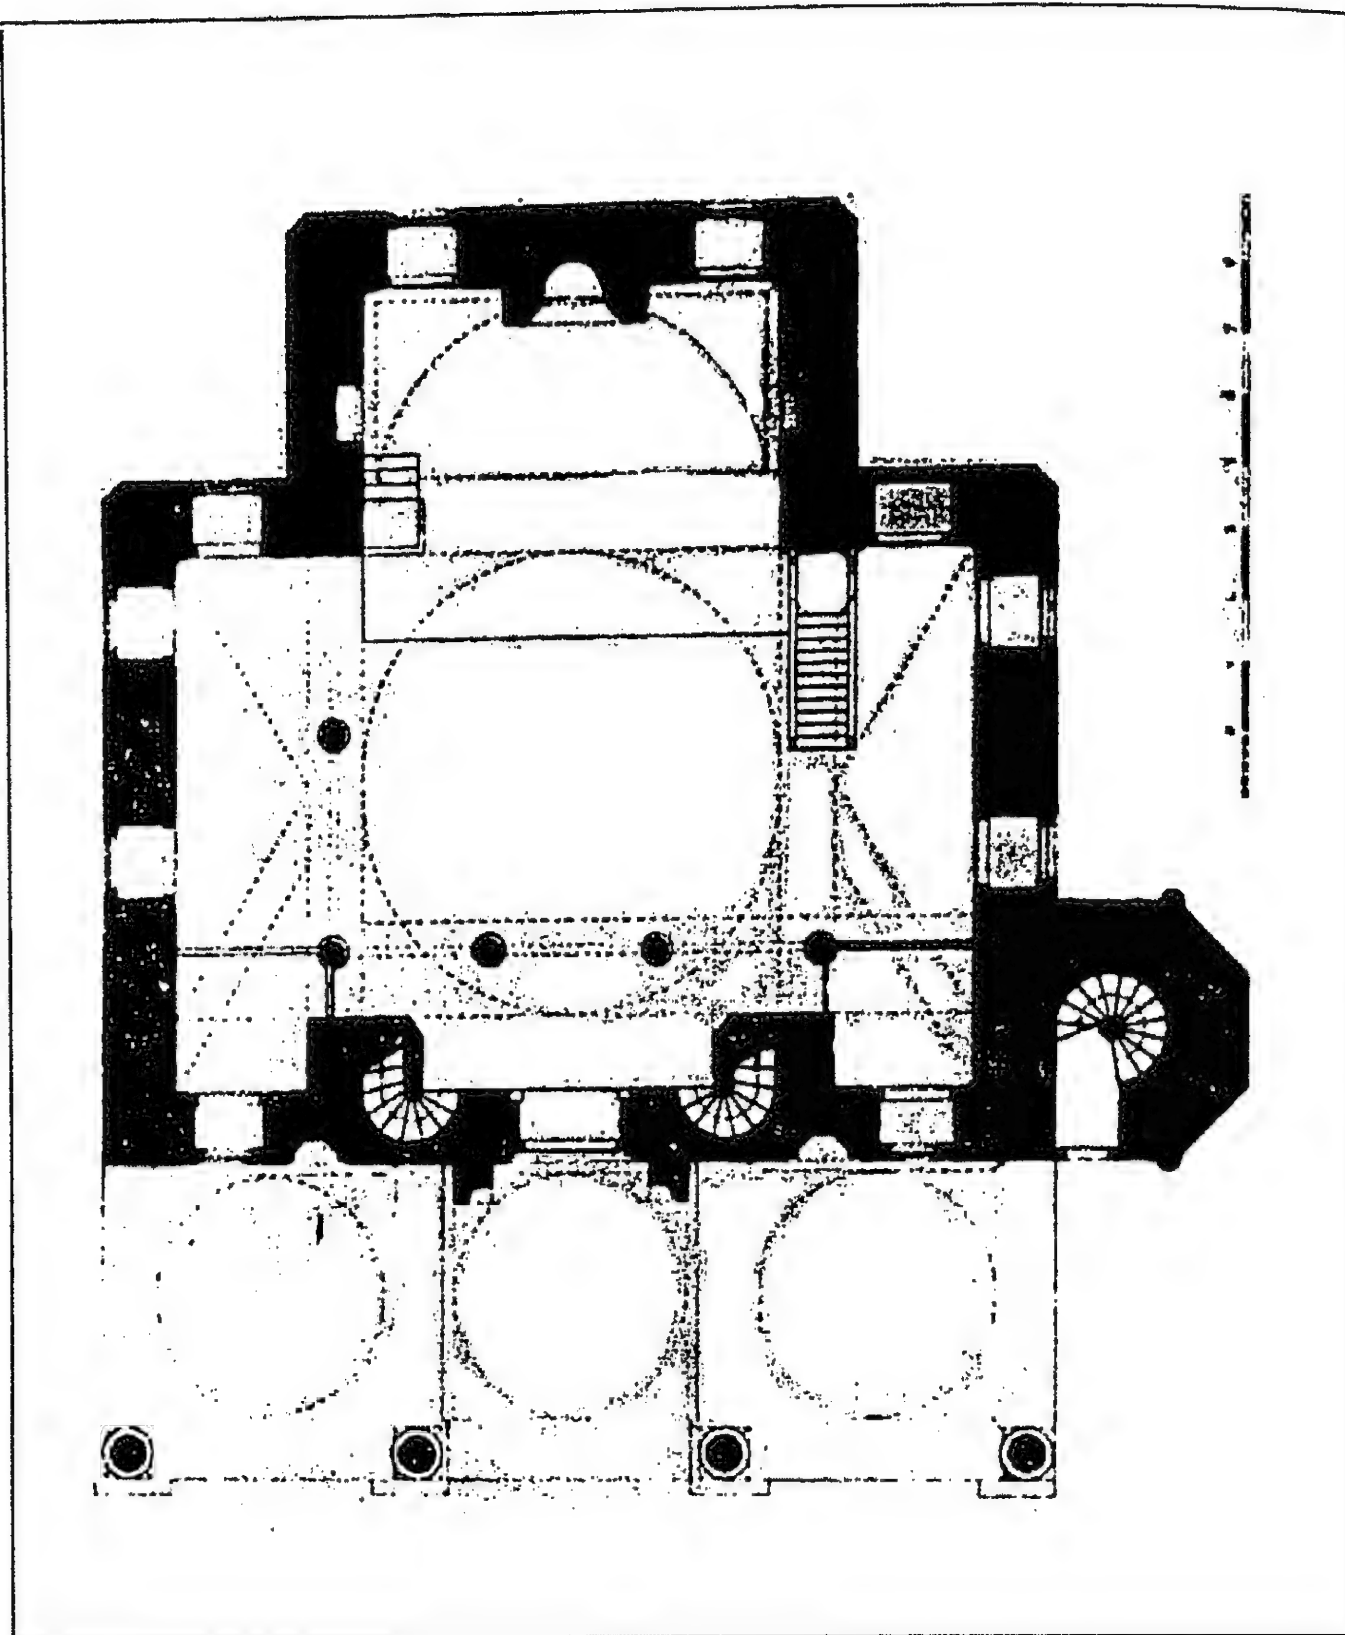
مسقط أفقي لمسجد مسيح باشا في إستانبول (عن : عبد الحافظ) .
